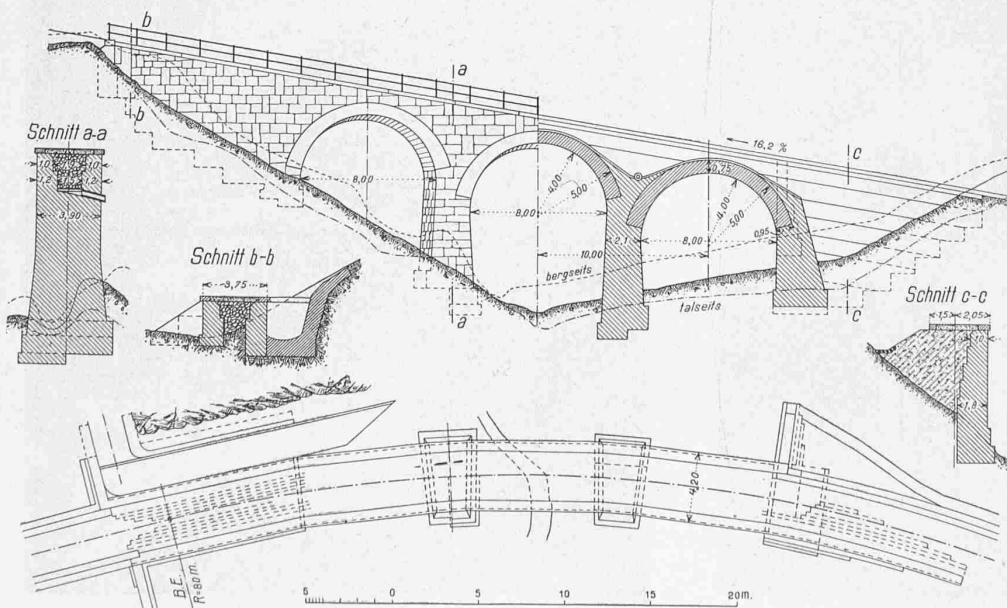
Ribibachviadukt. Ansicht, Grundriss und Schnitte. — Masstab 1 : 400.
